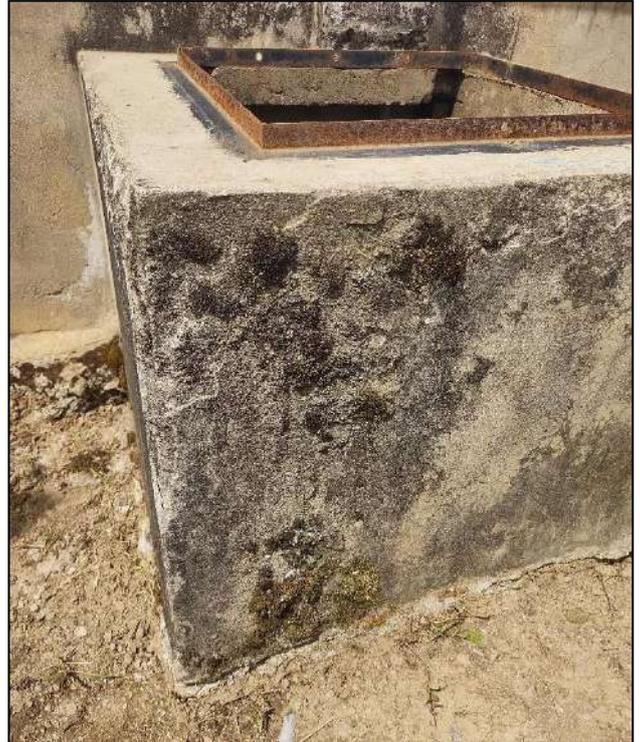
, Foto N° 11 – Sistema de cloración artesanal
